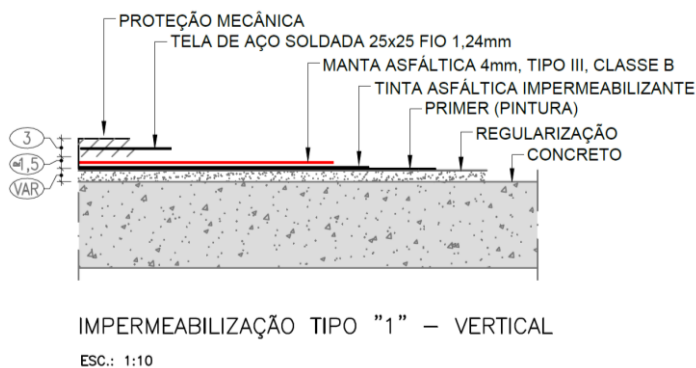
Detalhe construtivo de impermeabilização - paredes.
